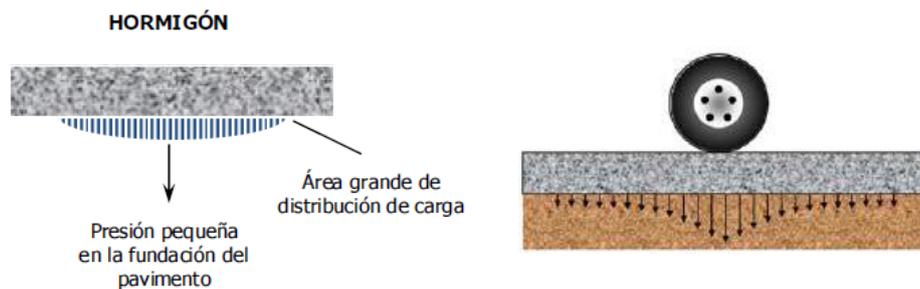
Esquema del comportamiento de pavimentos rígidos
